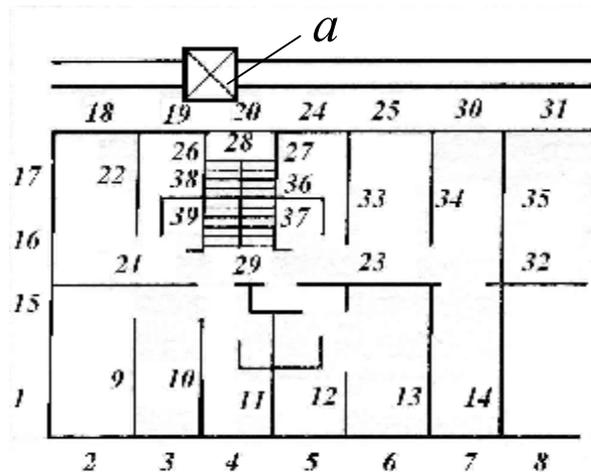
Схема установки панелей в бескаркасных зданиях с продольными несущими стенами: *a* – монтажный кран; 1, 2, 3... – порядковый номер очередности установки панелей
